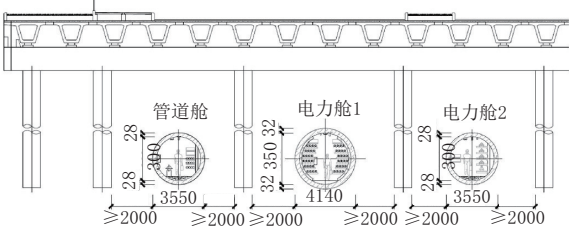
管廊从桥梁下方穿越断面图(方案一)(单位:mm)
